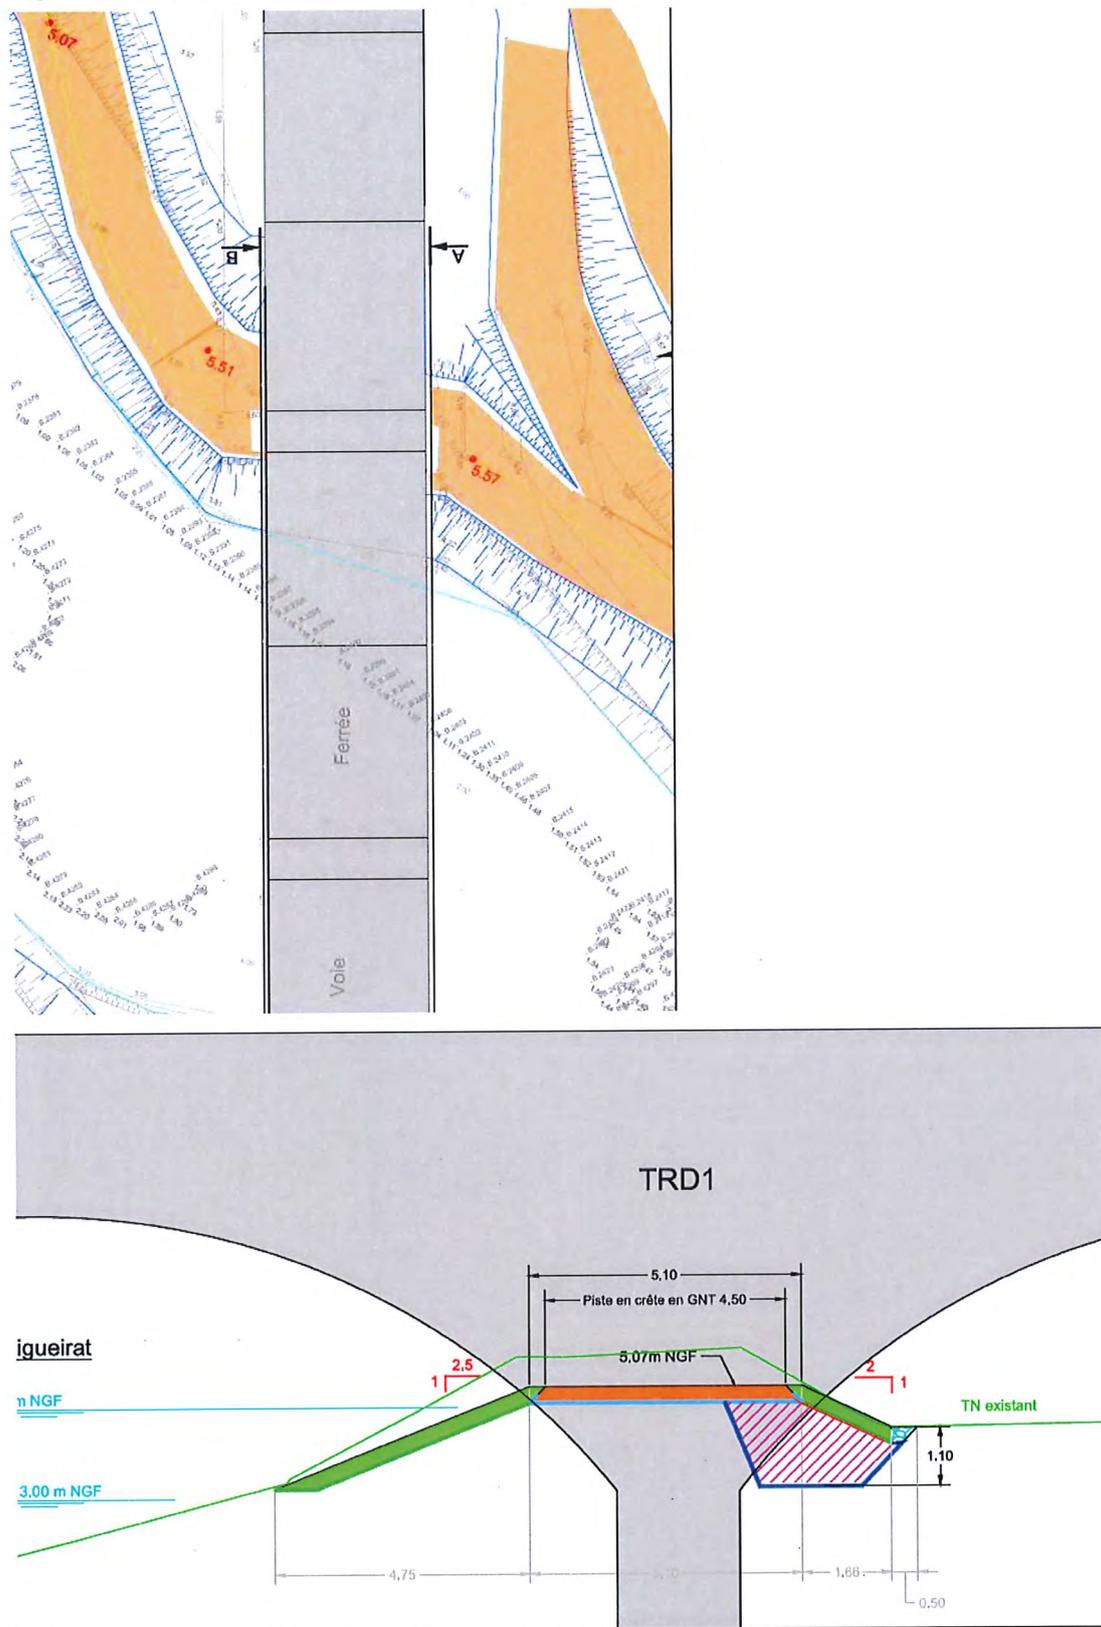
vue en plan / profil en travers au droit de la pile de la voie ferrée - rive droite du Vigueirat
